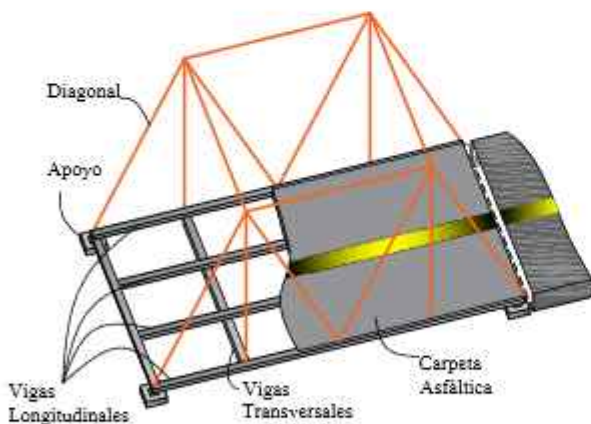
Uso de armaduras en estructuras metálicas - puentes
